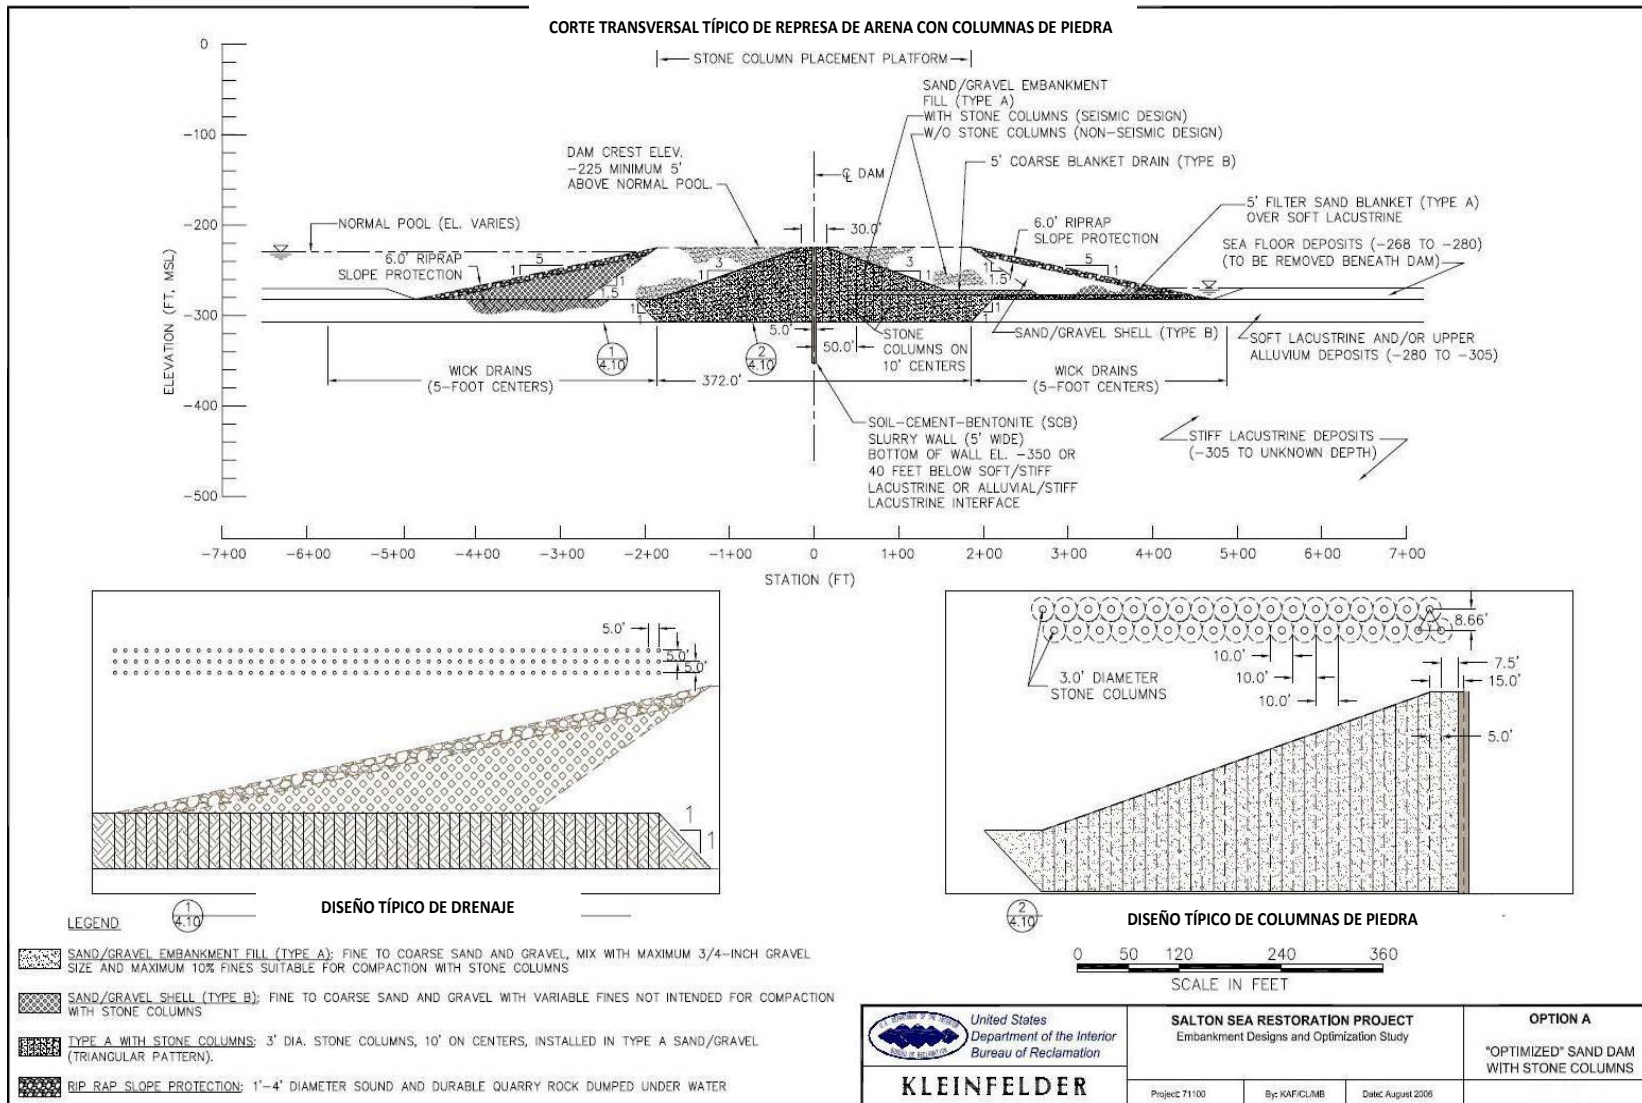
Corte transversal típico de represa de arena con columnas de piedra
